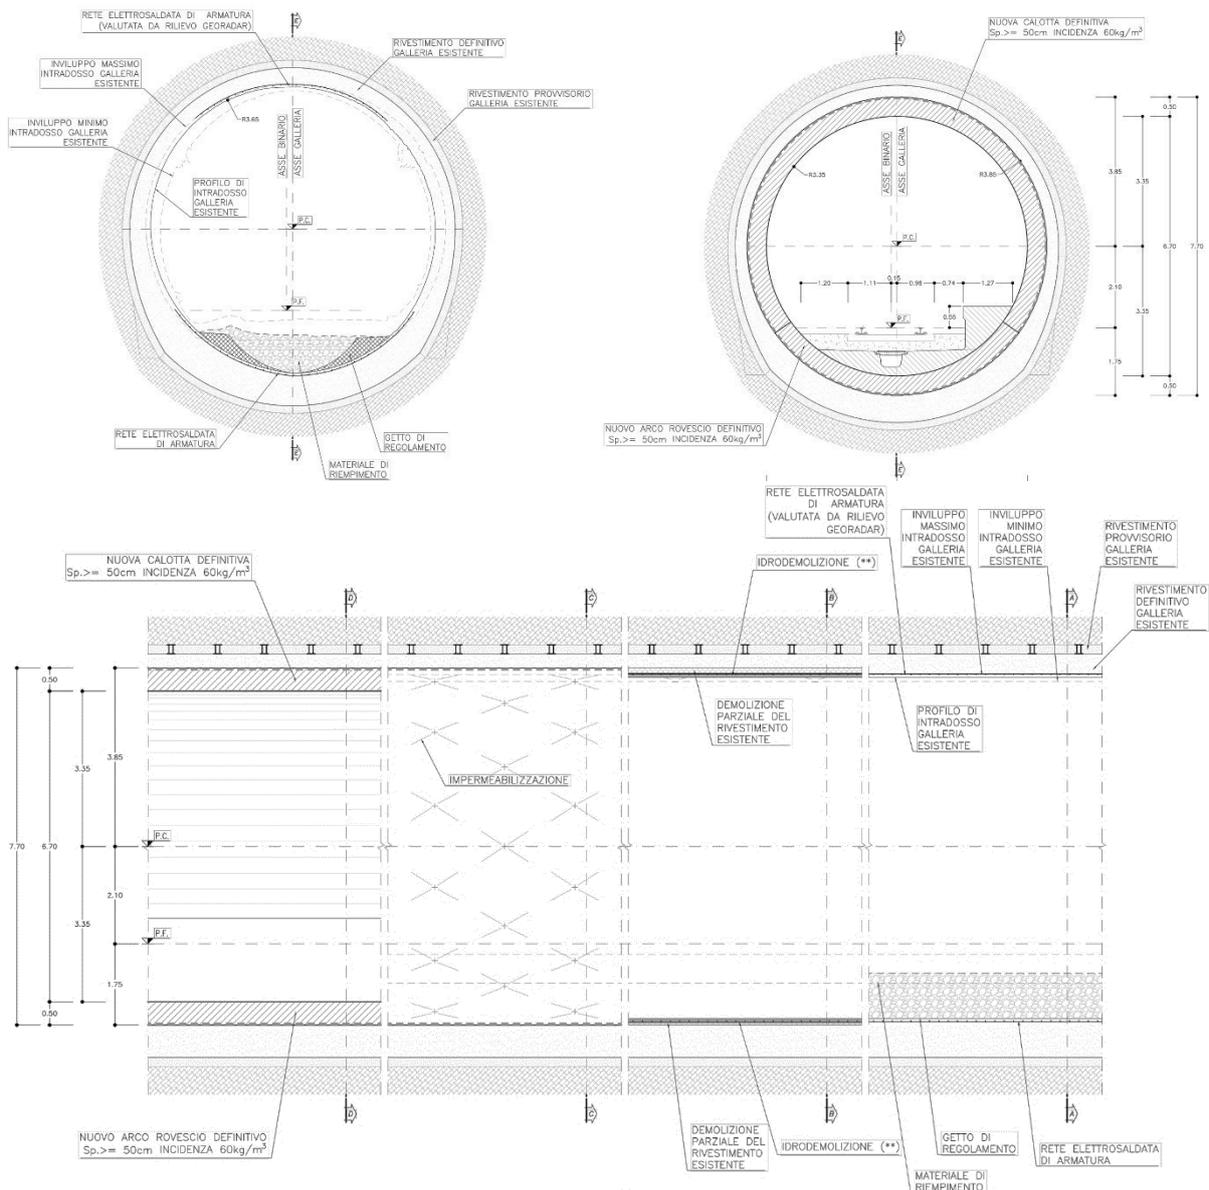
Sezione 2: sezione trasversale attuale (in alto a sinistra) e di progetto (in alto a destra) e profilo longitudinale (in basso) della Galleria con indicazione degli interventi previsti (da [2.9])
